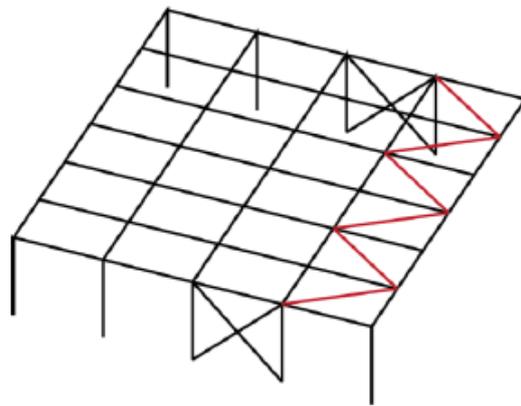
Poutre au vent transversale dont les panneaux ne comportent qu'une seule diagonale
